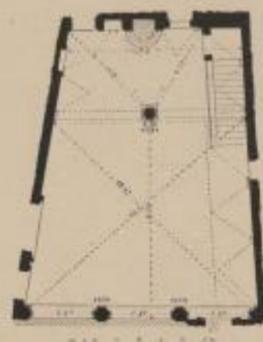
GRUNDRISS VOM HOF IM PALAST CANIGIANI.
